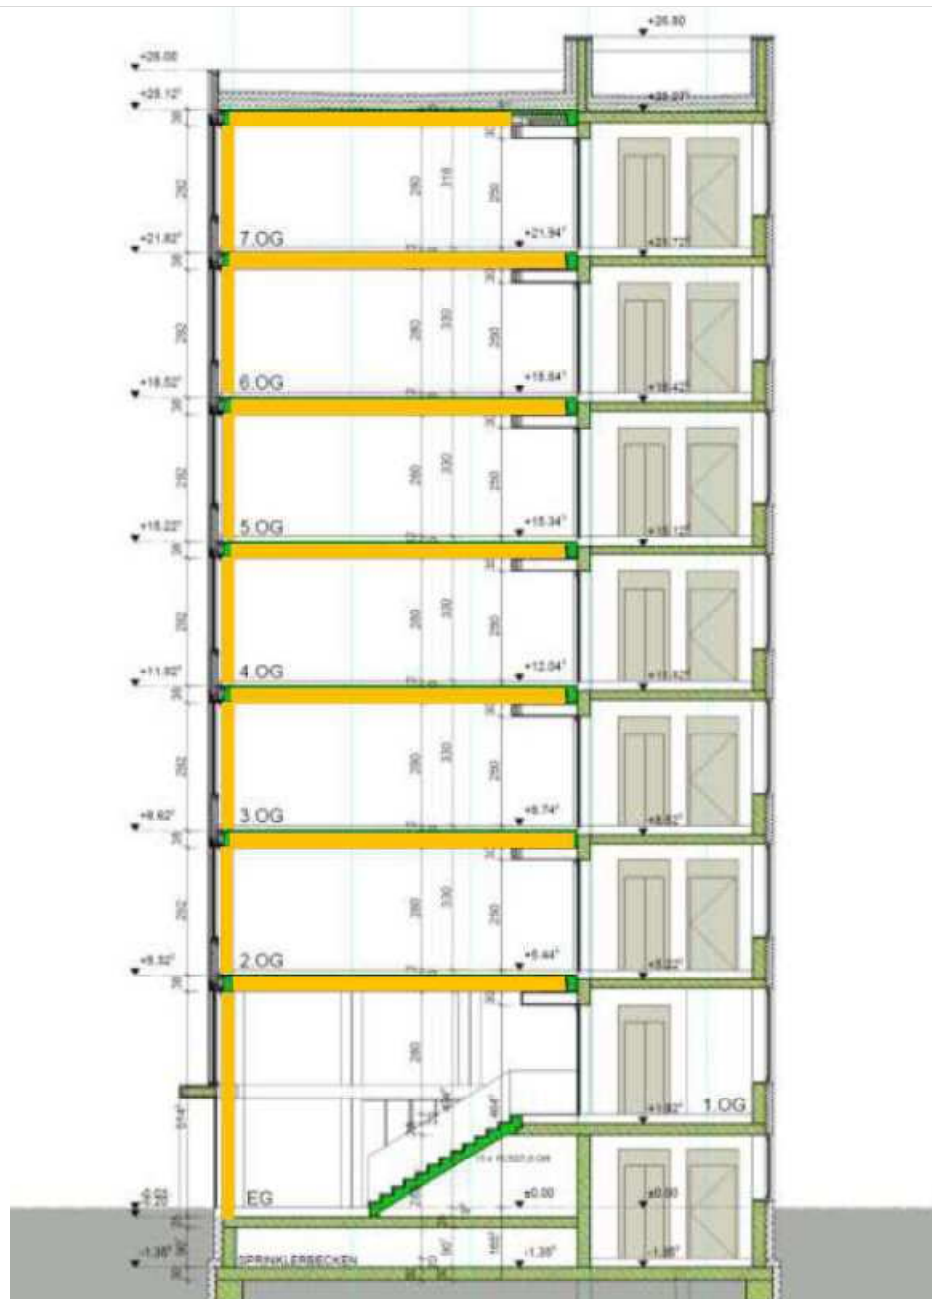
sezione trasversale (strutture in legno in giallo, verdi in C.A.)
